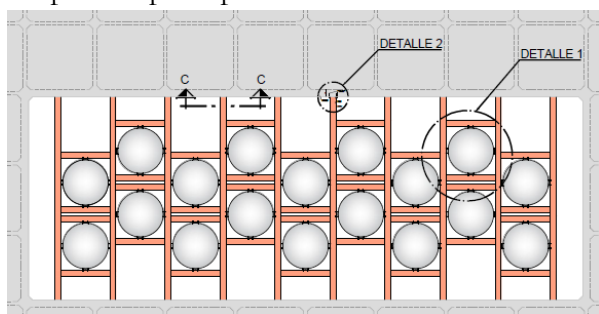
Configuración en planta del sistema de arriostramiento de los depósitos.
